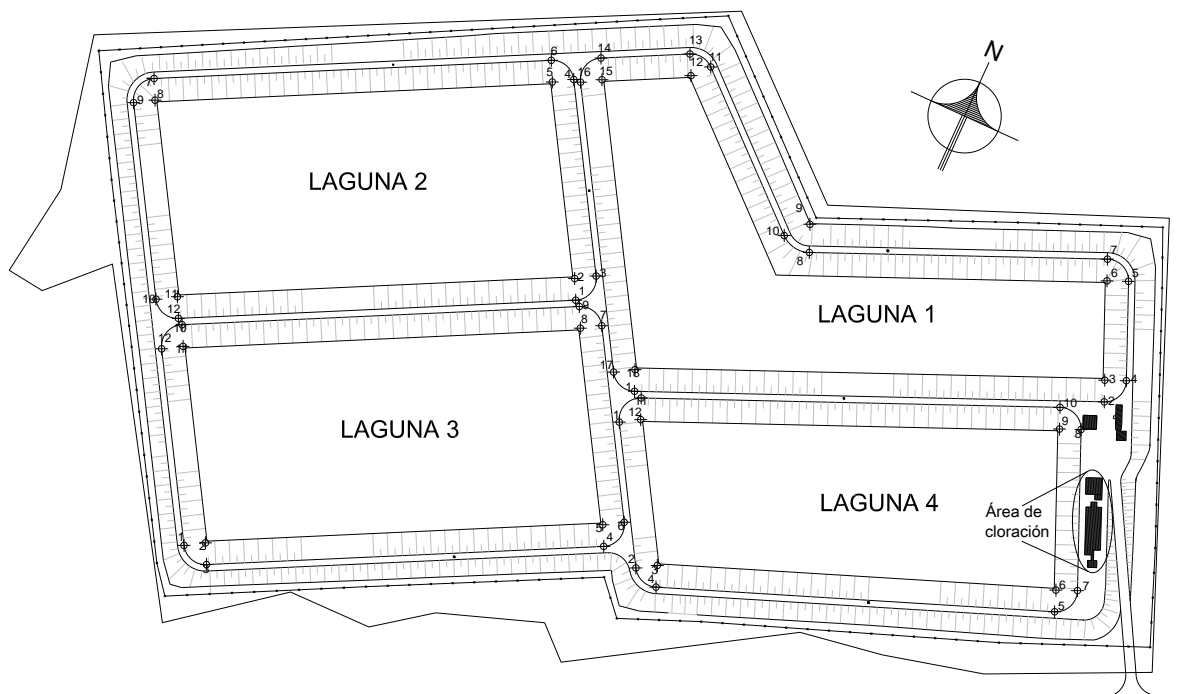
Plano de la Planta Norte de San Luis Potosí, SLP.
